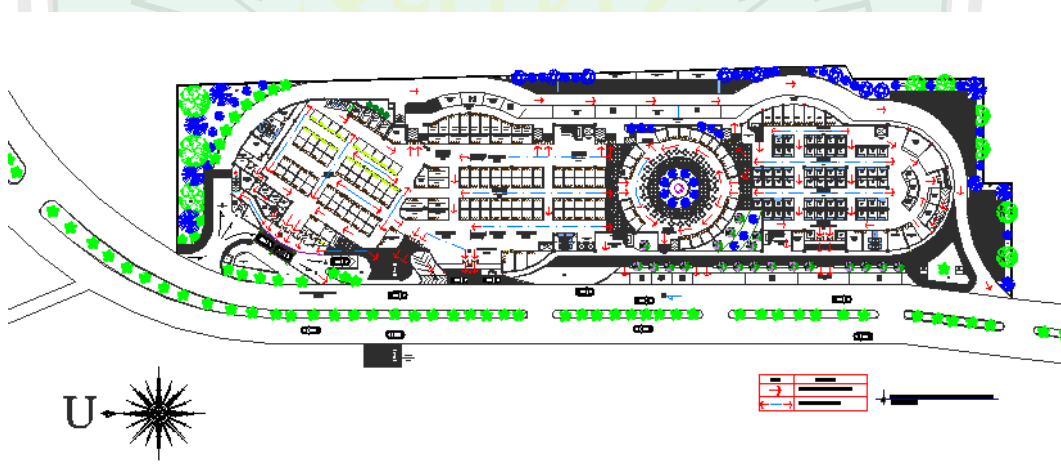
Sistem Sprinkler, Detector, dan Alarm pada Lantai 3
